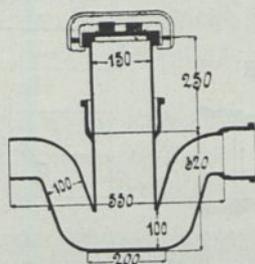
Syphonartiger Wasserverschluß mit Reinigungsöffnung.
